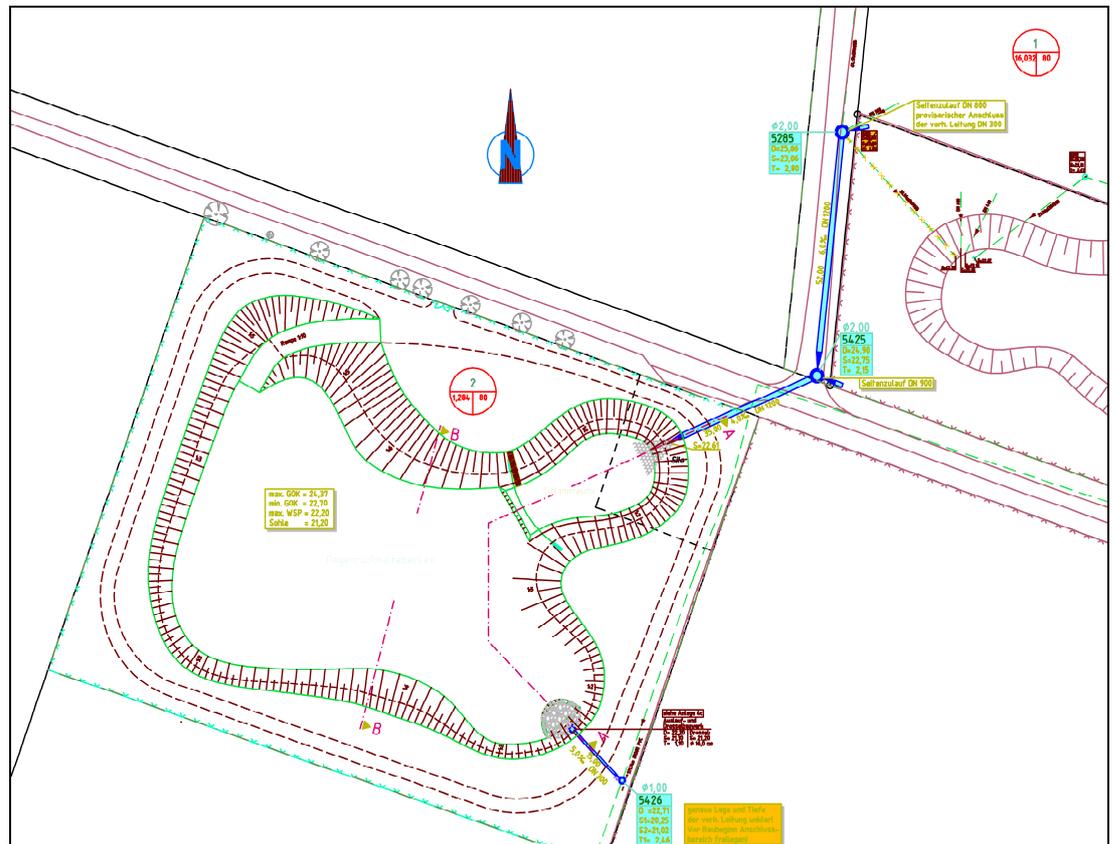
Lageplan des neu genehmigten Rückhaltebeckens
